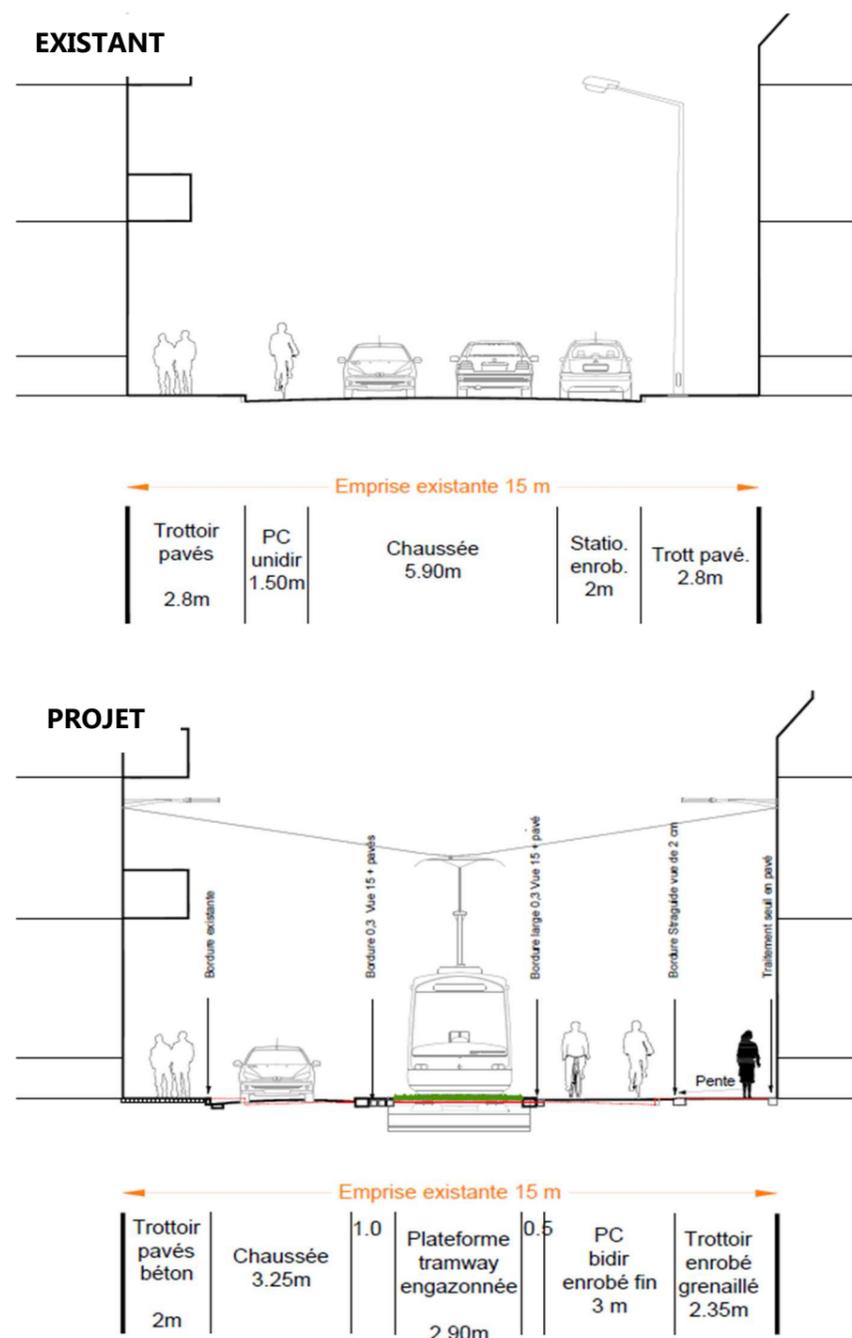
Coupe Route du général de Gaulle Sud (source : AVP GETAS, 2023)
